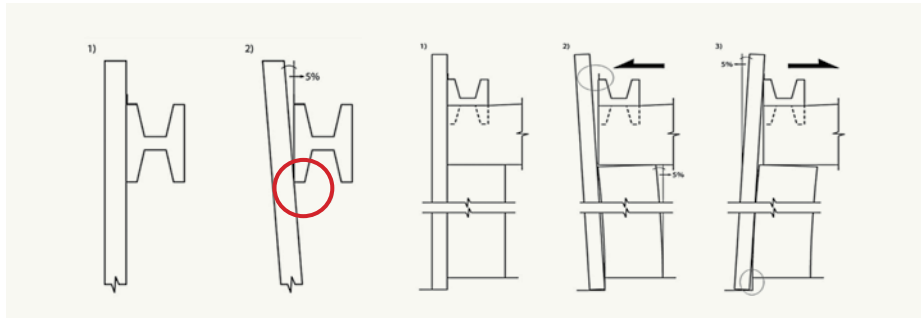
Conexión de paneles prefabricados a viga de borde de sección H.
